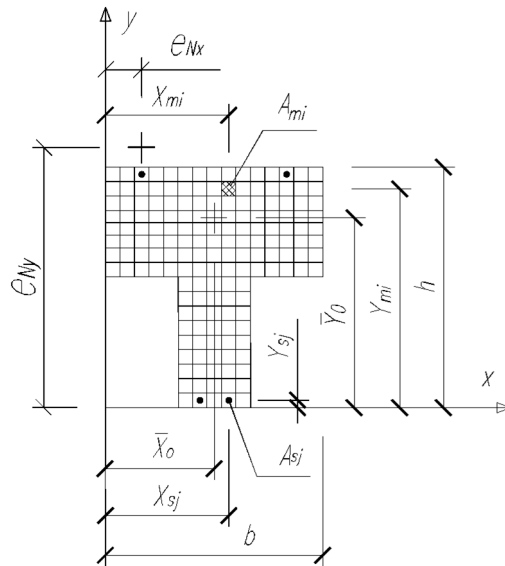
Расчетная схема нормального к продольной оси сечения, разбиение на элементарные площадки
